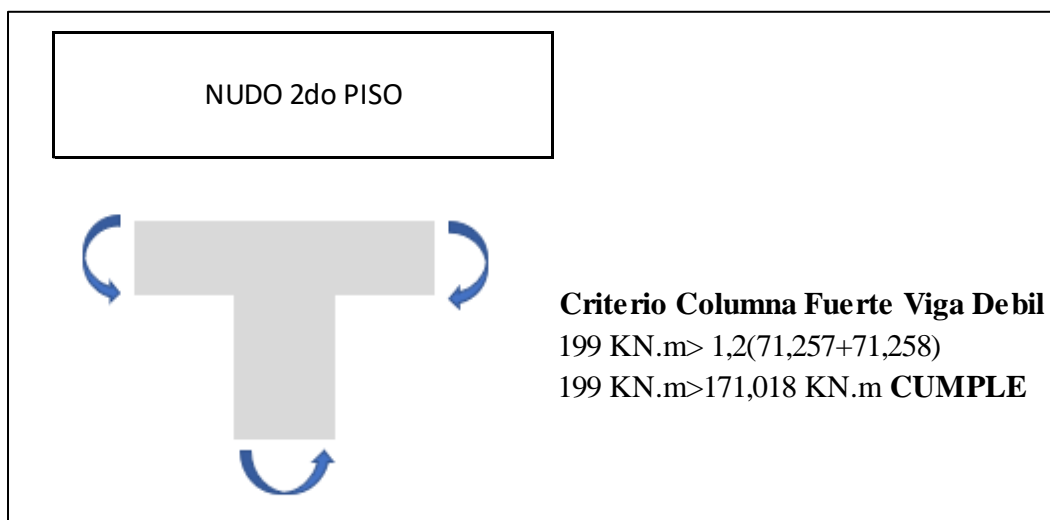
Criterio viga fuerte y viga débil de la columna C2 y C3
